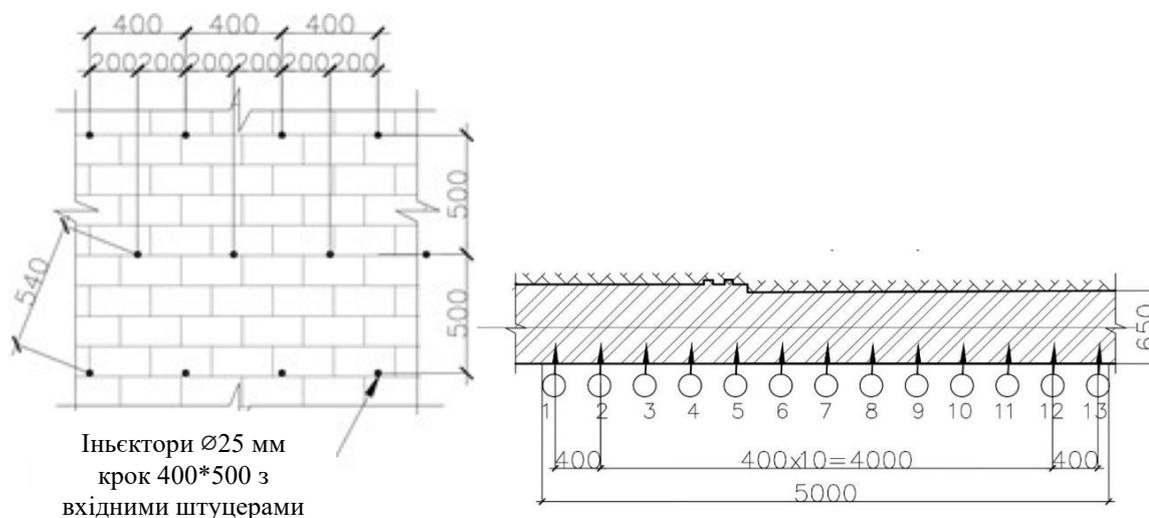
Схема розташування ін'єкційних отворів у конструкції: а – вид збоку; б – вид зверху
